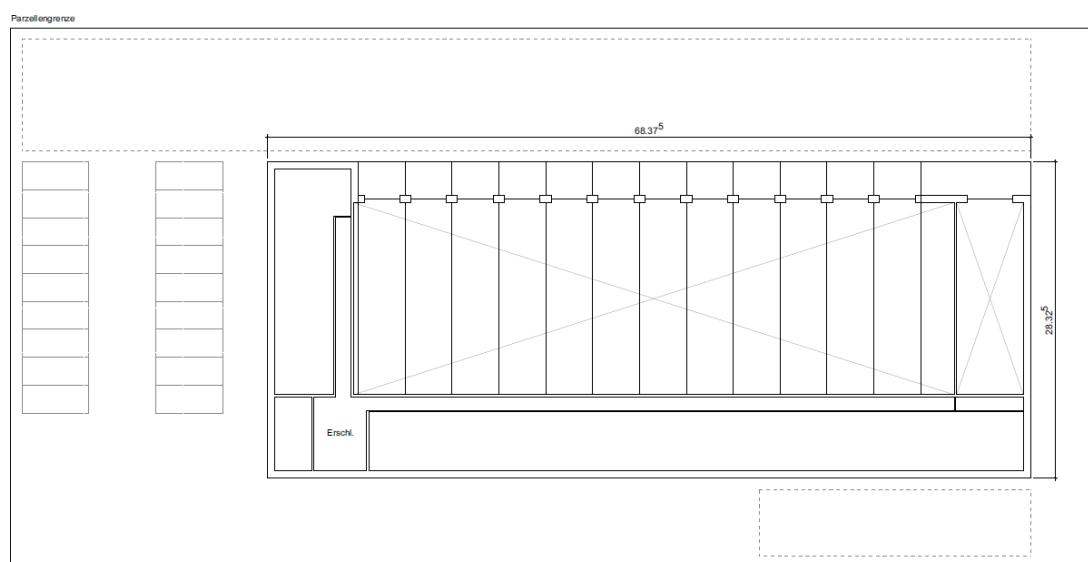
Flächenprüfung 1. Obergeschoss, Beispielgrundriss
